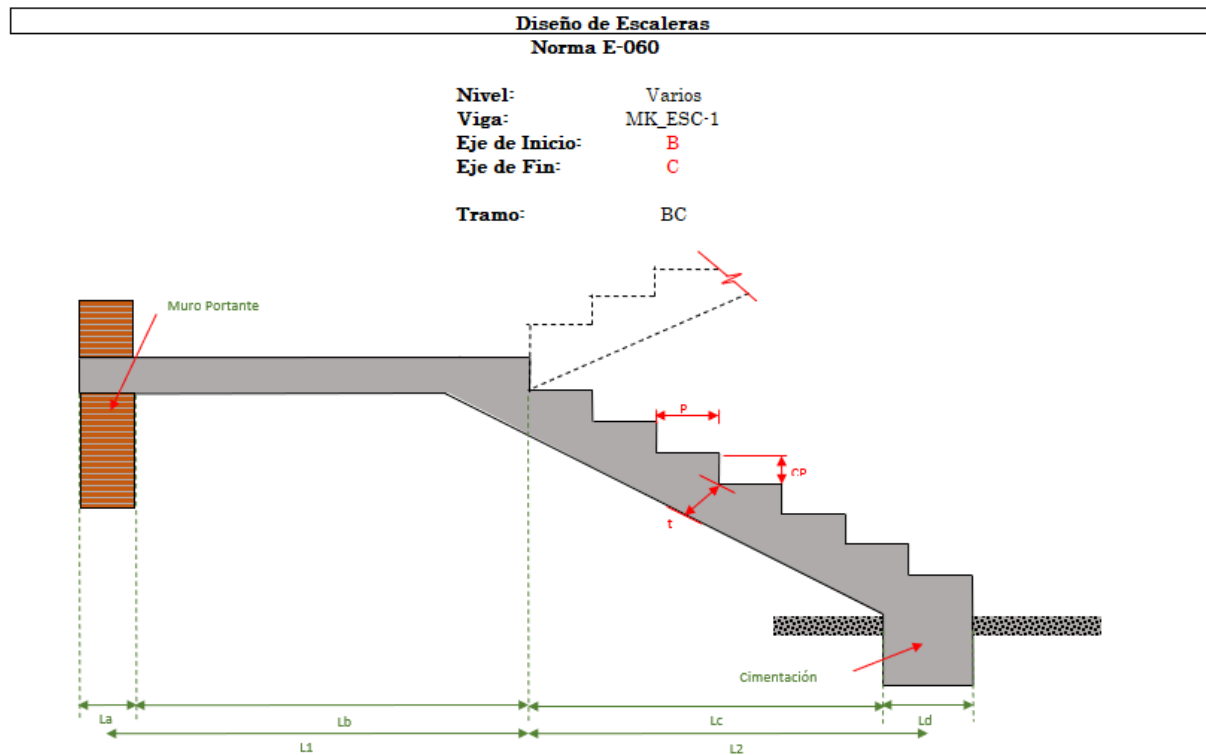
Detalle Típico de Geometría de Escalera en Sección.
